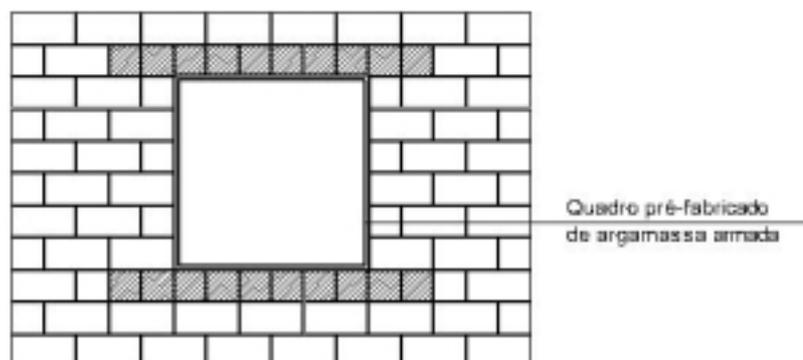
FIGURA: Detalhe de verga e contraverga empregando-se blocos canaletas
